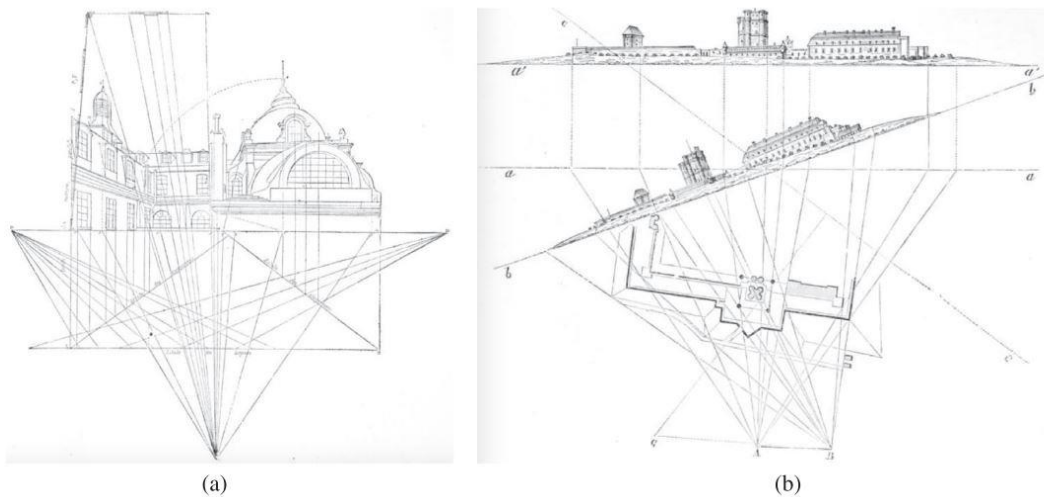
Fachadas levantadas por Laussedat en 1850 gracias a su sistema de levantamiento fotogramétrico (Granshaw, 2019: 132).
